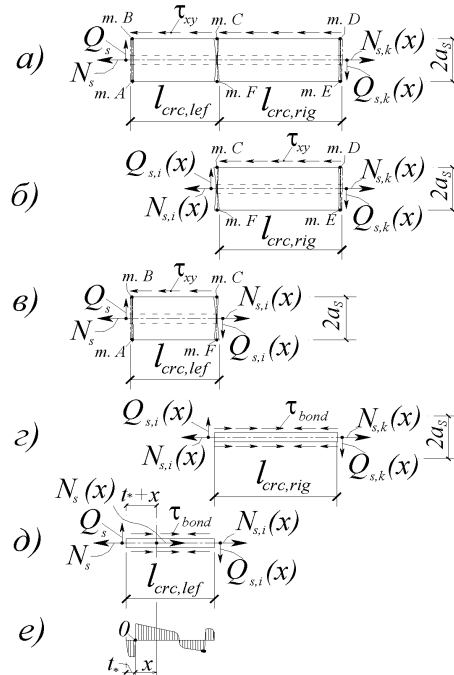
К составлению условий равновесия для определения деформаций растянутого бетона между трещинами и равновесия продольного арматурного стержня для соответствующего уровня образования трещин
